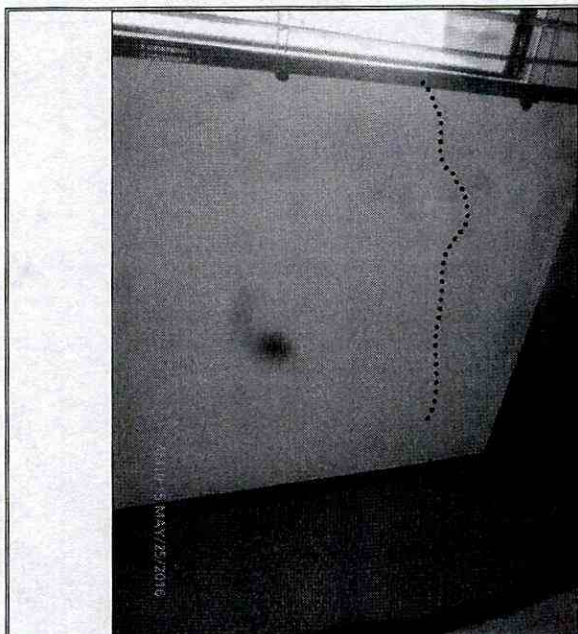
Fisuras en muros de cerramiento y divisorios en las viviendas 29 y 30 del conjunto residencial Plazuelas de Iberia 2, en el Sector Catastral Prado Veraniego Norte de la Localidad Suba.
